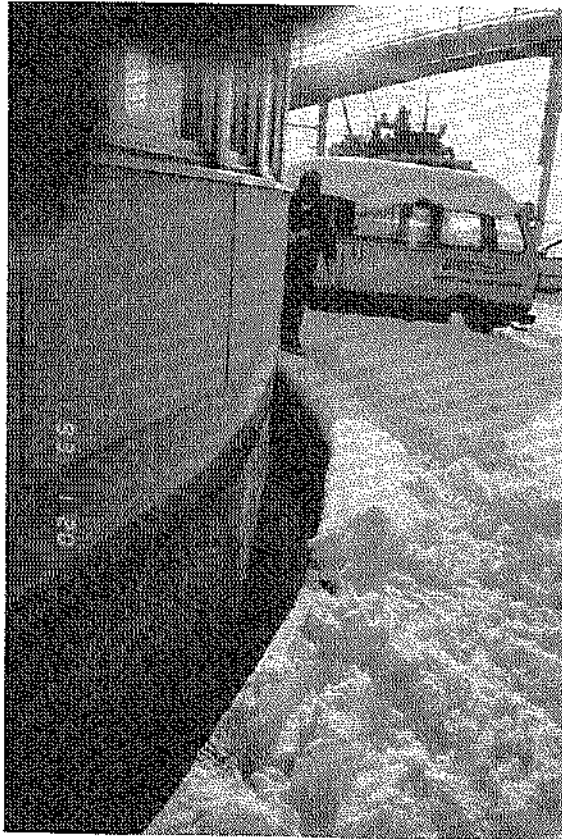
フェリーターミナル基礎の段差・開き状況(第1埠頭地区, ㊤西側岸壁(-9.0m))
